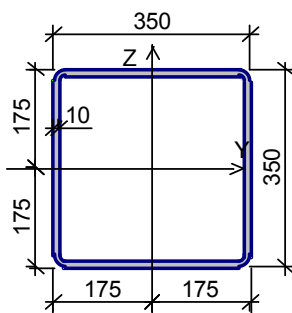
Принятое поперечно сечение верхнего пояса фермы
